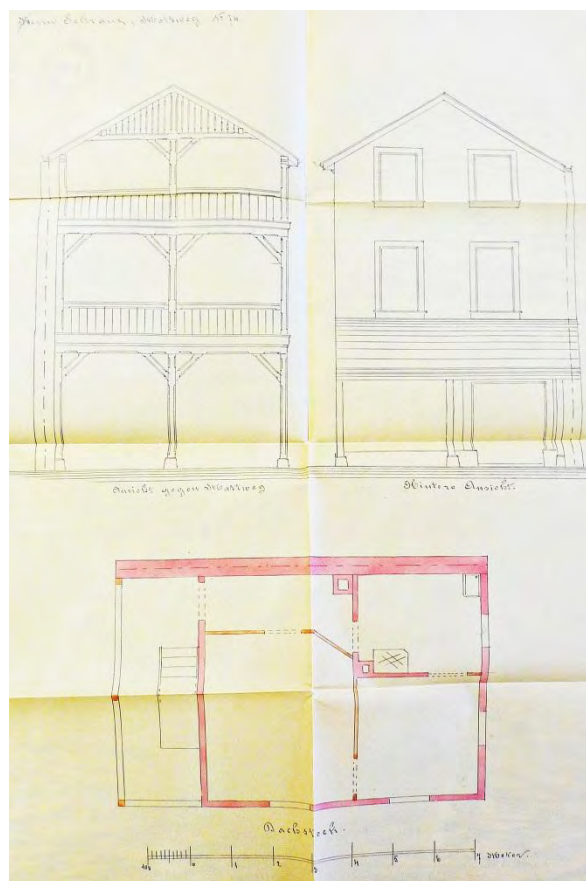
Fassaden mit offener Veranda und Grundriss des Dachstocks
